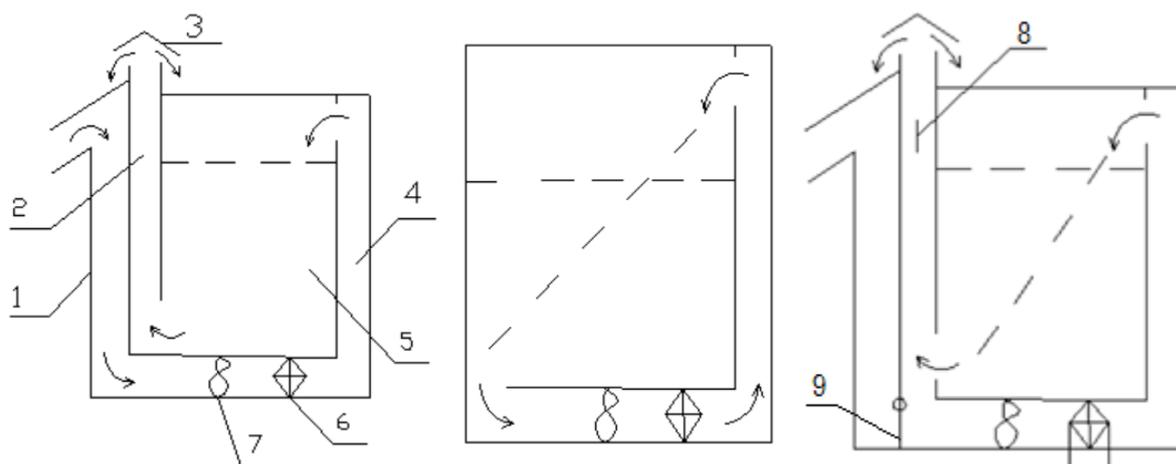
Система воздушной вентиляции а) прямоточные б) с полной рециркуляцией, в) с частичной рециркуляцией: 1 – воздухозаборная шахта, 2 – вытяжная шахта, 3 – вентиляционный зонт, 4 – воздуховод, 5 – рабочая зона, 6 – калорифер 7 – вентилятор, 8 – утепленный обратный клапан, 9 – поворотный регулирующий клапан.
